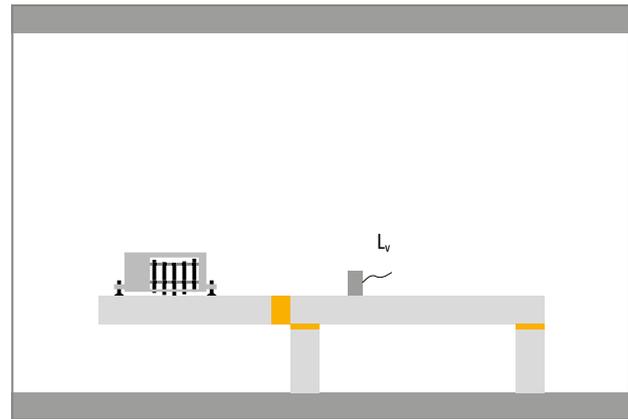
Bestimmung des Schnellepegels  $L_v$  mit tragendem Wärmedämmelement
